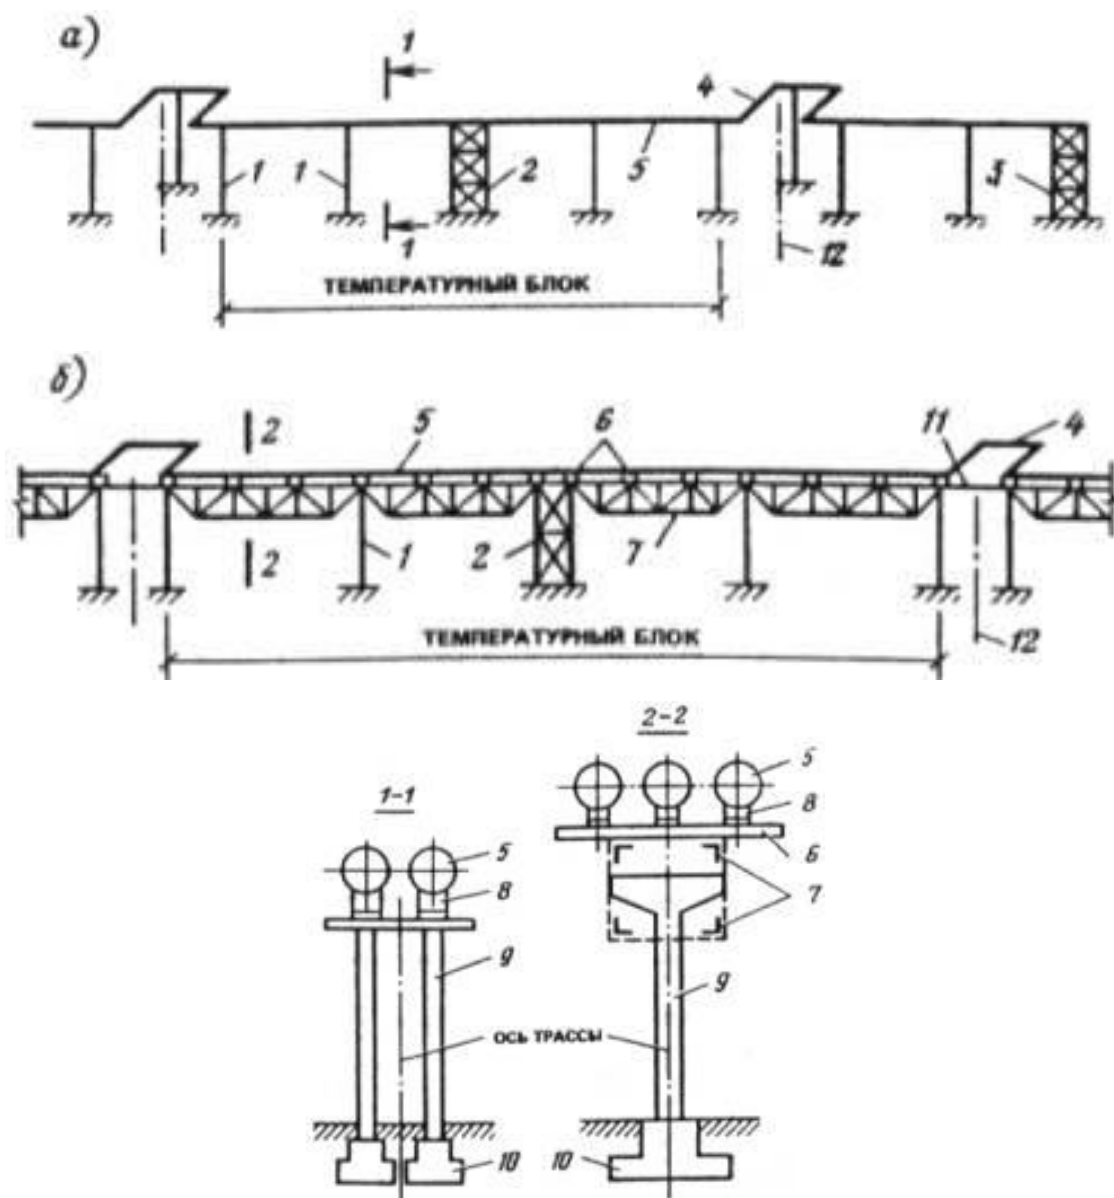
Схема прокладки трубопроводов по опорам и эстакадам
